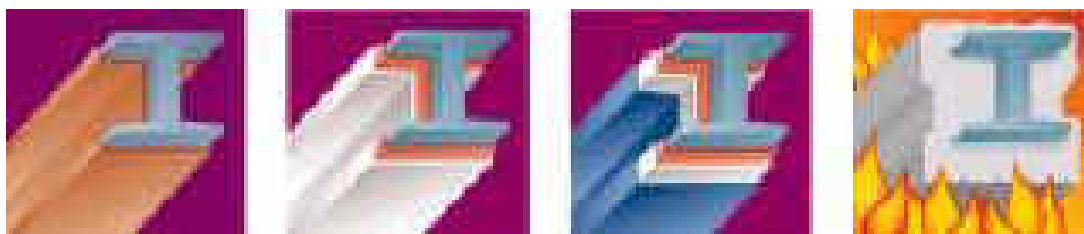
Esquema de aplicação da tinta intumescente e sua expansão volumétrica em situação de incêndio.
